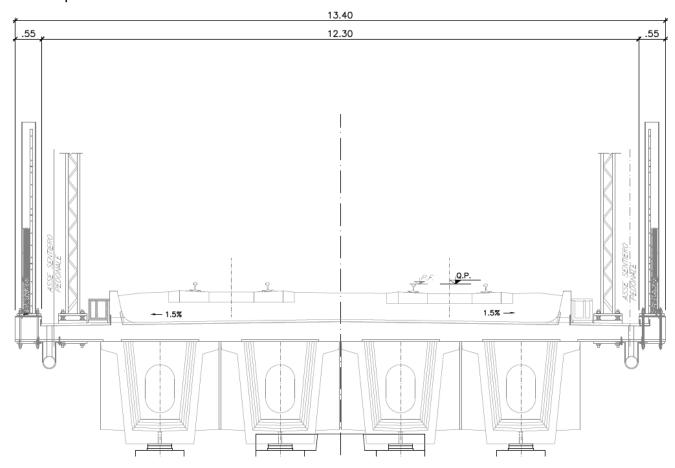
Sezione tipo - trasversale impalcato con travi c.a.p.
